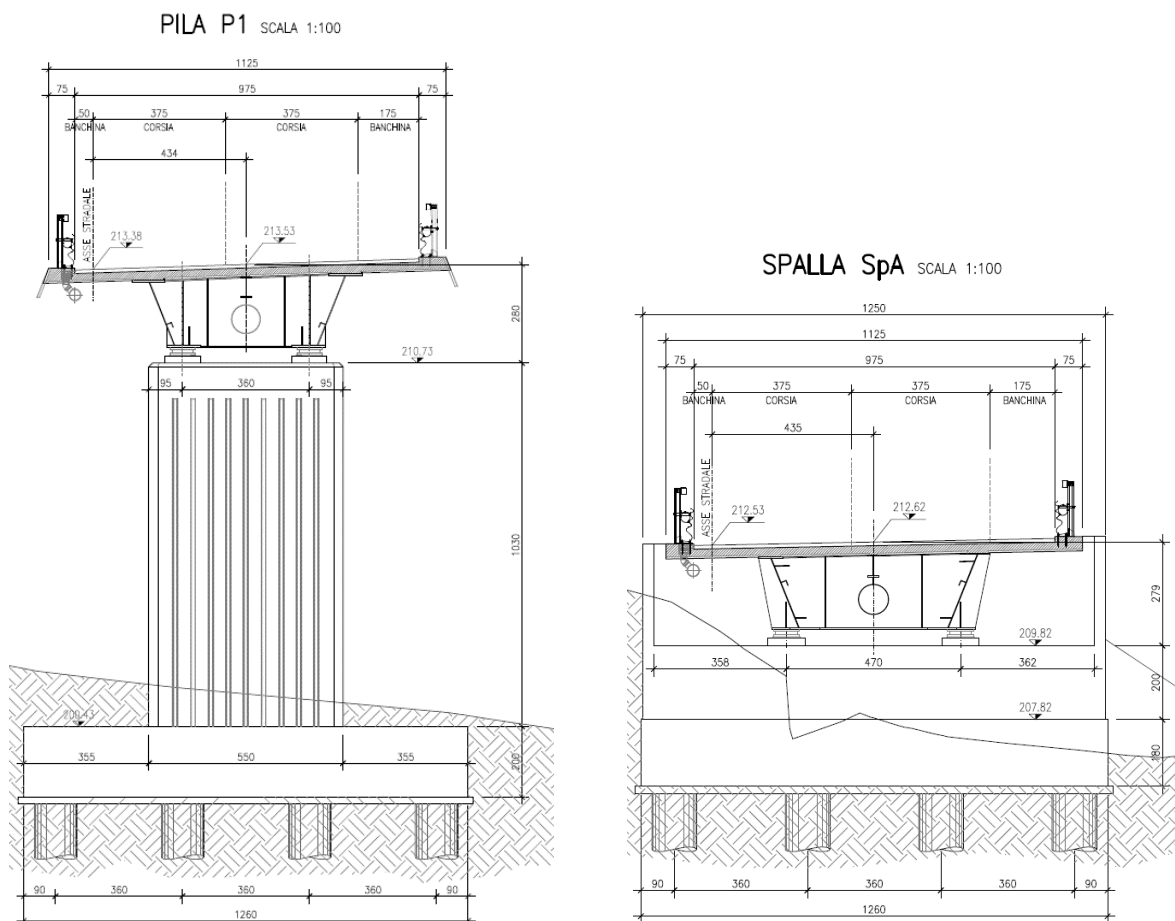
viste e sezioni principali – Sezioni su pila e spalla
